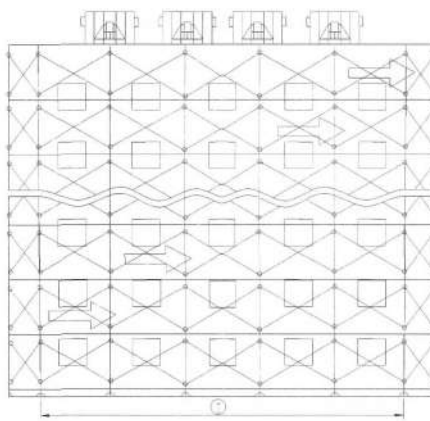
Розподіл фасаду на захватки при проведенні робіт з будівельного рихтування
